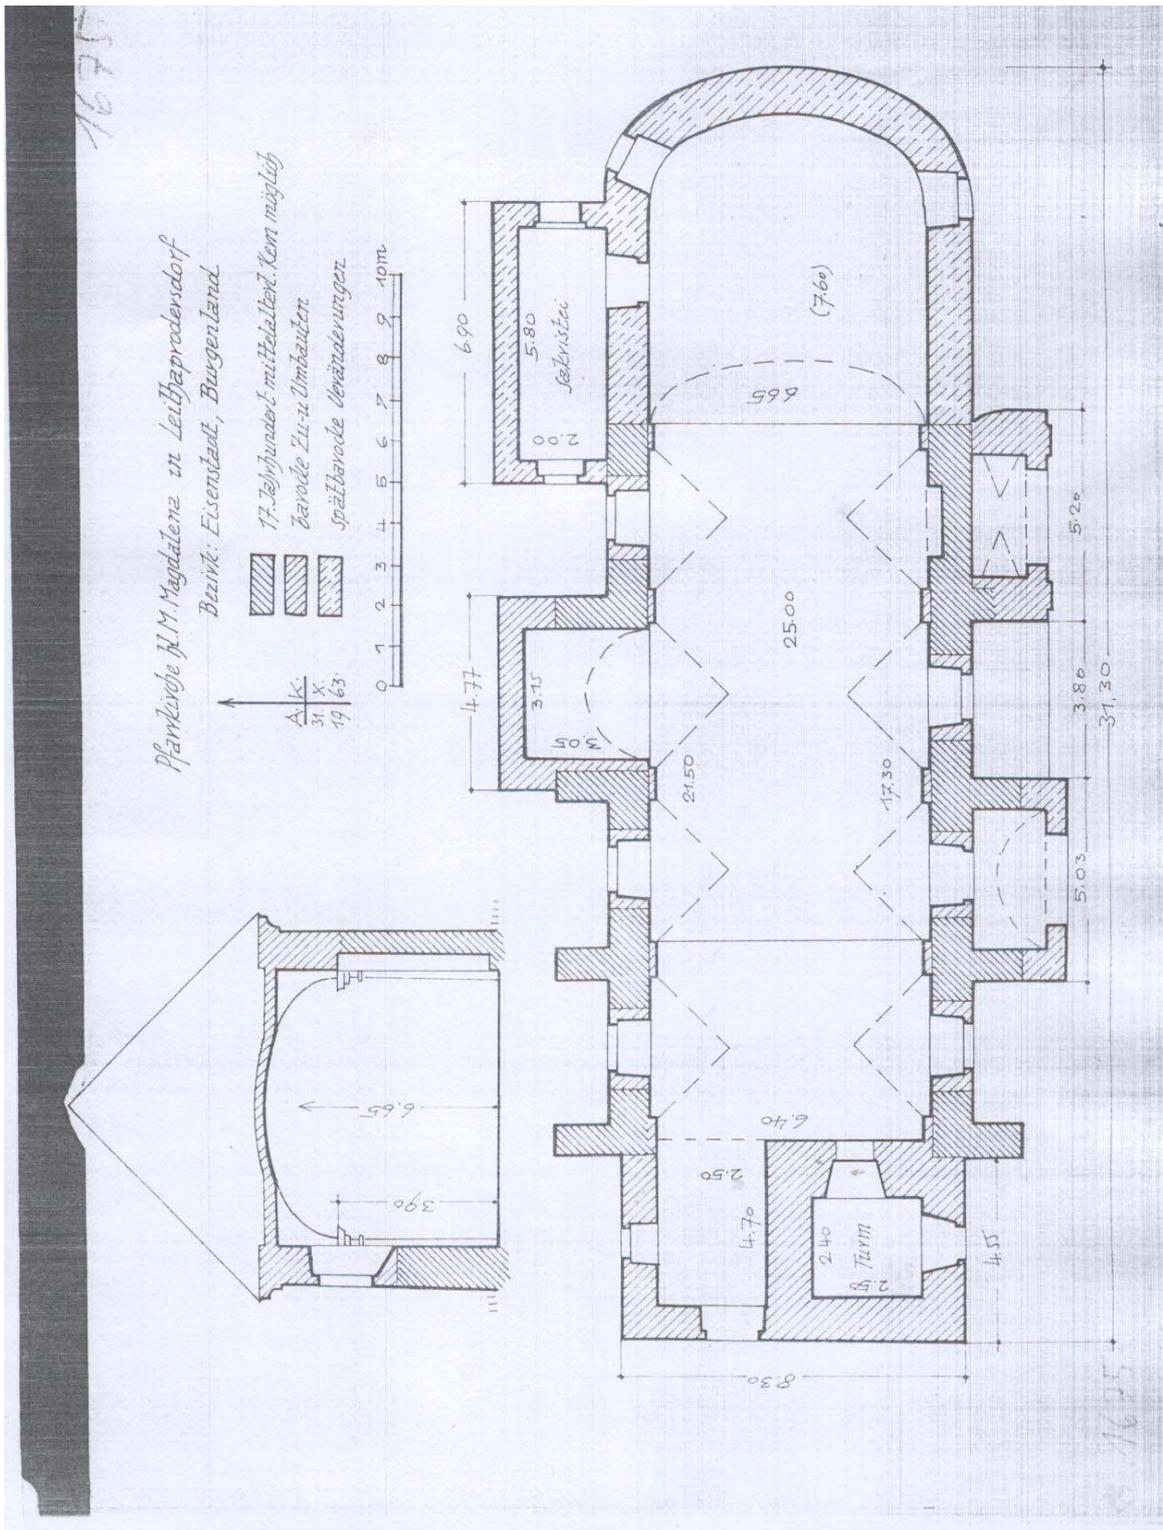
, Grundriss 4, Leithaprodersdorf, Pfarrkirche³²⁴
